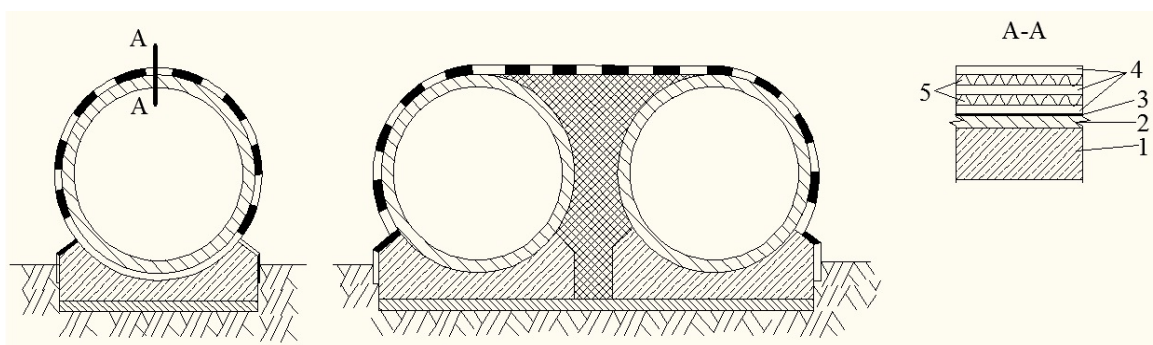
Двухслойная армированная битумная оклеечная изоляция типа БМ-1, применяемая на сборных железобетонных круглых водопропускных трубах: 1 – звено трубы; 2 – подготовительный слой; 3 – битумная грунтовка; 4 – три слоя битумной мастики толщиной 1,5–2 мм; 5 – две прослойки армирующей ткани
